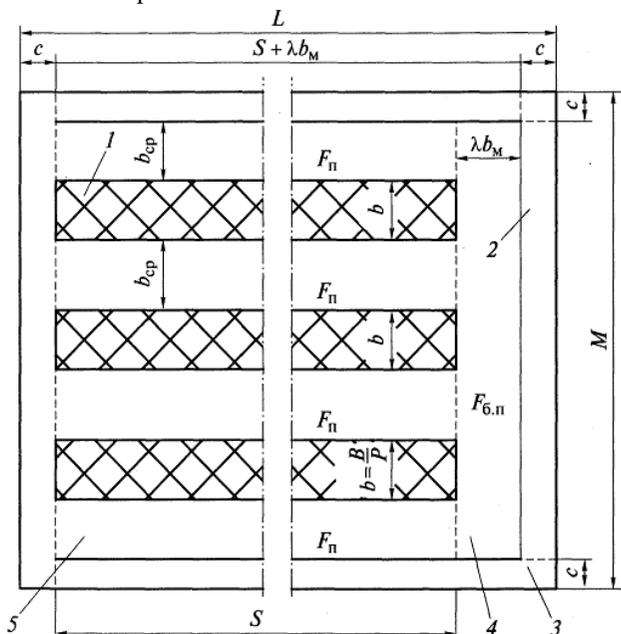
Схема к расчёту площади зоны хранения техники на открытых площадках:
